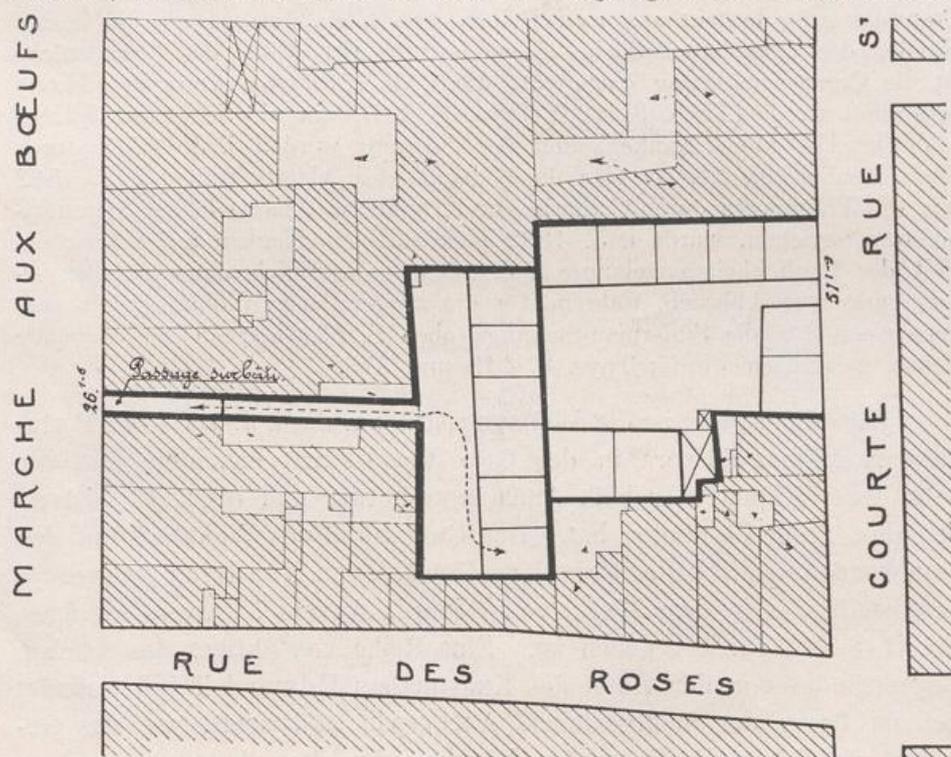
Stiftungen Franciscushof und van Dale, Grundriß. Maßstab 1 : 650.
